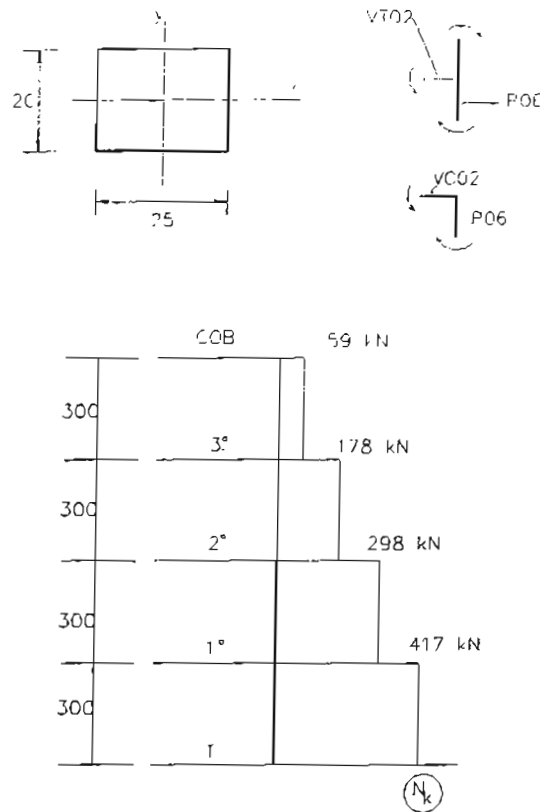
Somatória de ações nos pavimentos e seção transversal do pilar P06
